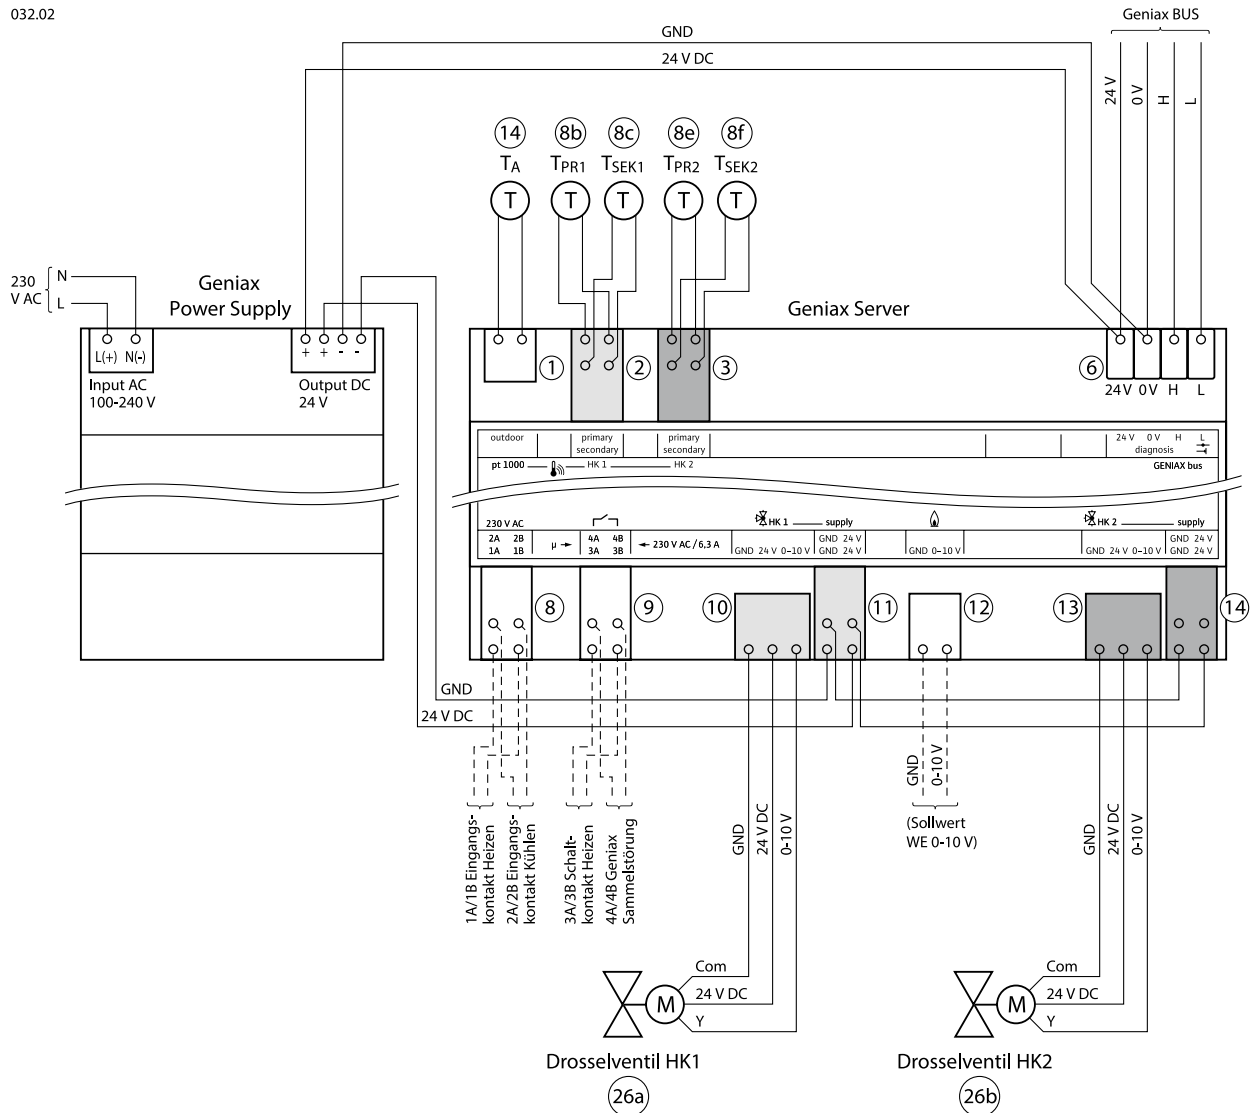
Verdrahtungsplan 32a zu Anlagenschaltbild 032: Drosselventile/Mischer mit Stellmotoren für Gleichstrom 24 V DC
